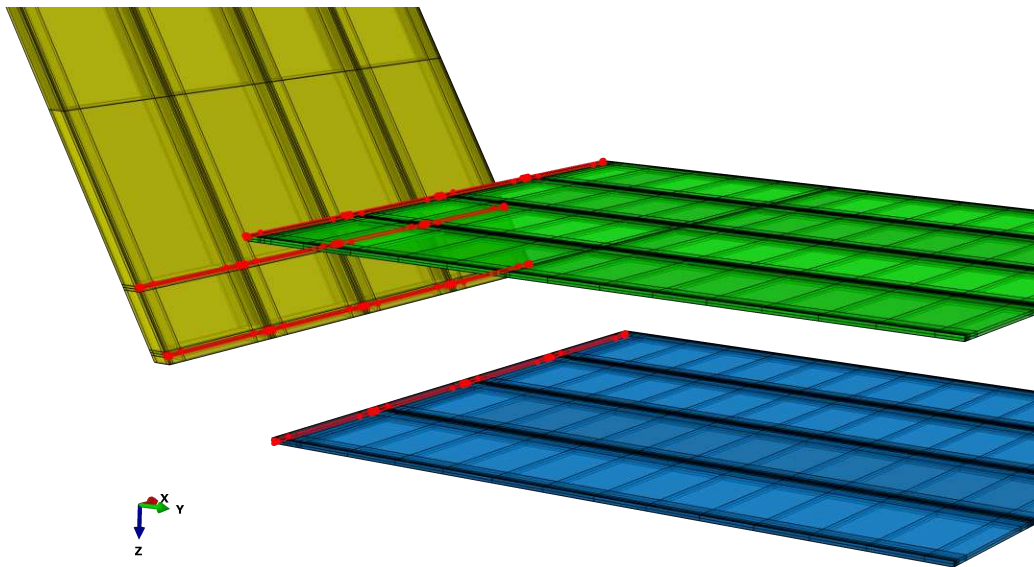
Schweißnähte zwischen Steg und Deck- bzw. Bodenblech (*tie-constraints*)
